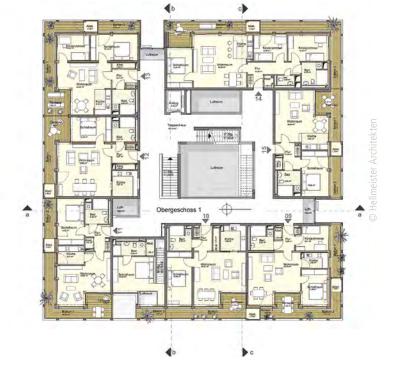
Der Grundriss des 1. Obergeschosses mit den um den Erschließungskern gruppierten Wohneinheiten
